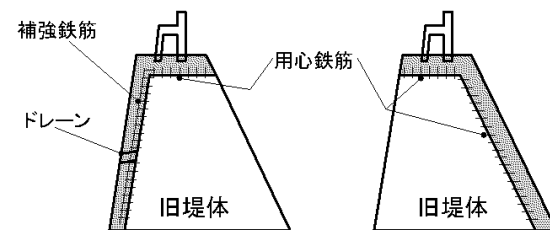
新旧コンクリートおよびコンクリート・鋼材部の一体化
